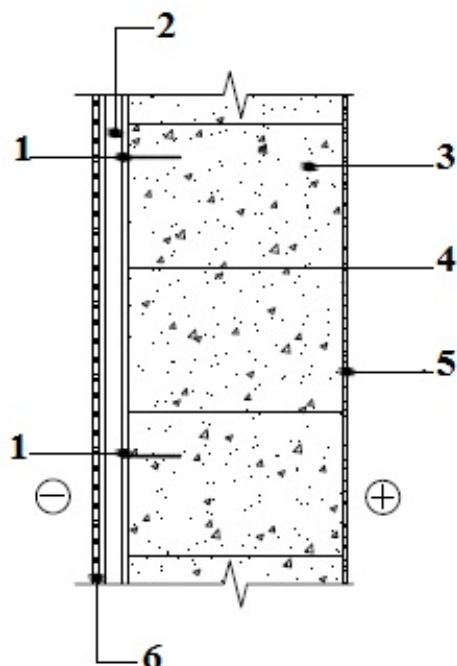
Стеновой блок и система вентилируемого фасада: 1 — анкер, шаг по проекту; 2 — металлические направляющие; 3 — блоки YTONG; 4 — раствор для тонкошовной кладки YTONG; 5 — внутренняя отделка; 6 — навесной фасад (сайдинг, керамогранит, композитные панели и пр.)
